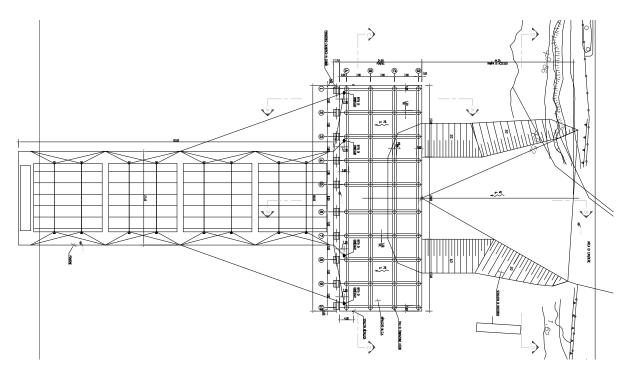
planimetria dell'accosto provvisionale per l'attracco delle chiatte di trasporto conci
